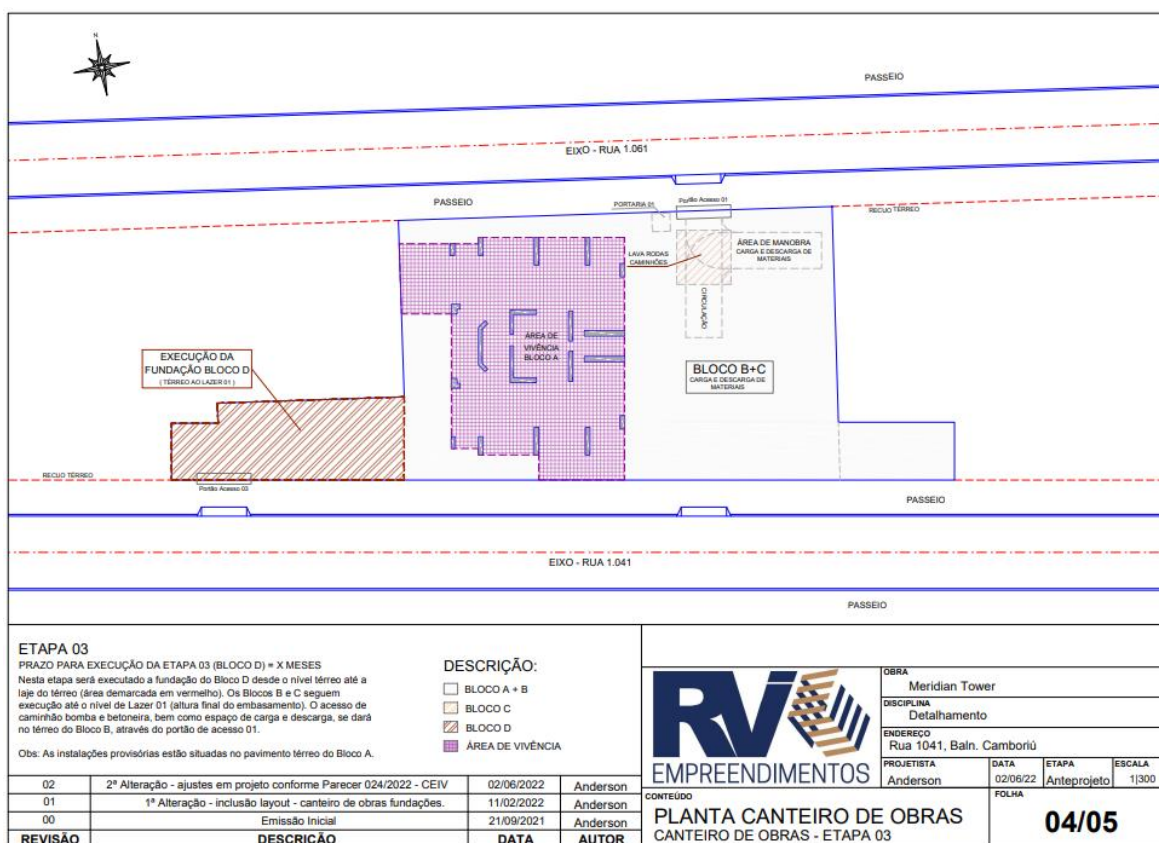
Projeto do canteiro de obras. Prancha 04/05
